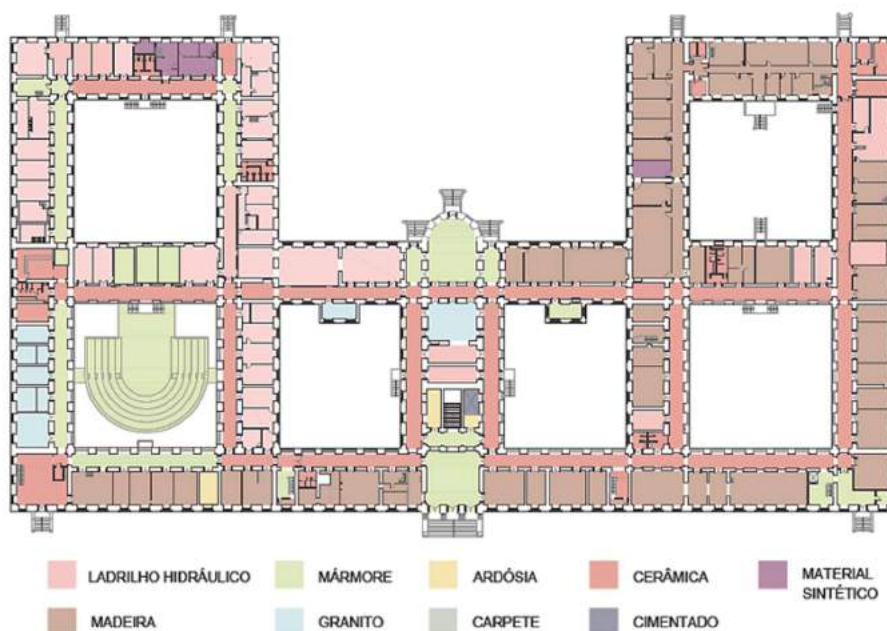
Planta esquemática de tipos de pisos do primeiro pavimento do Palácio Universitário.
